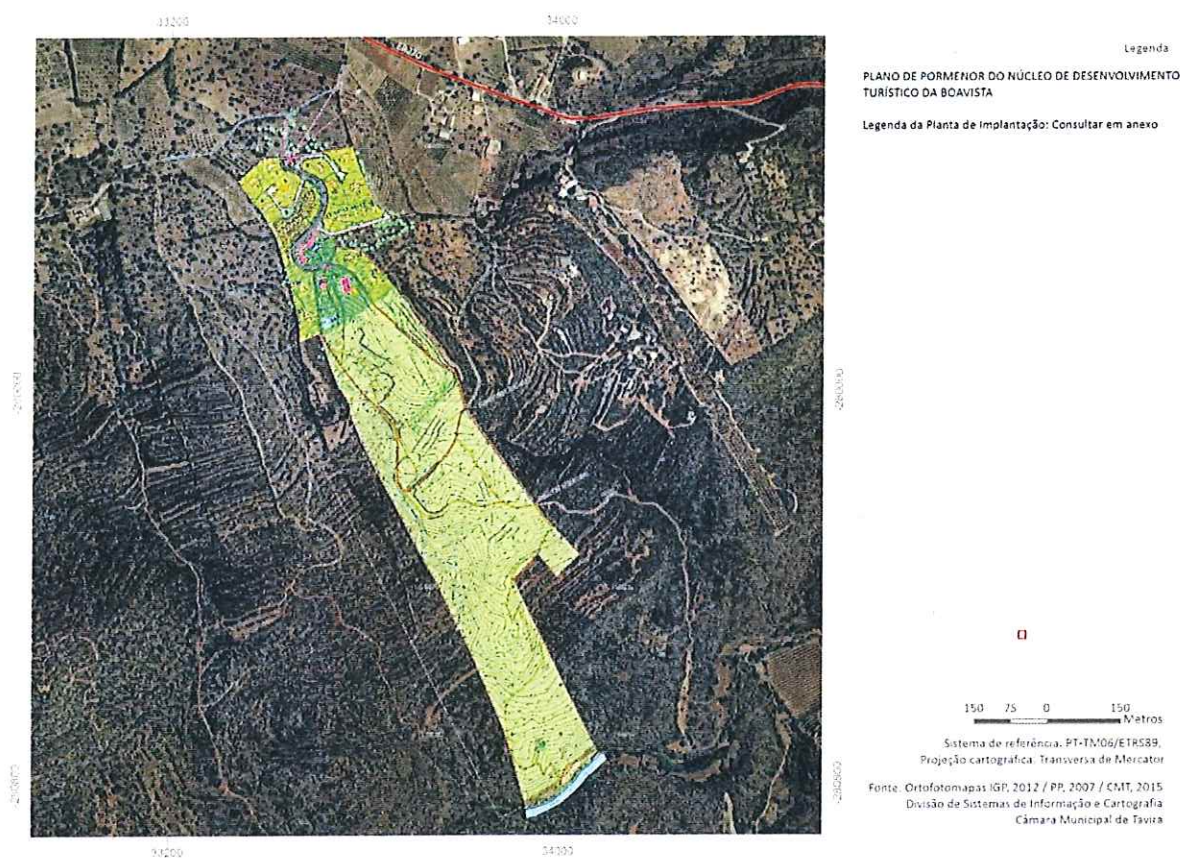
| Planta de Implantação do PP do NDT da Boavista.
